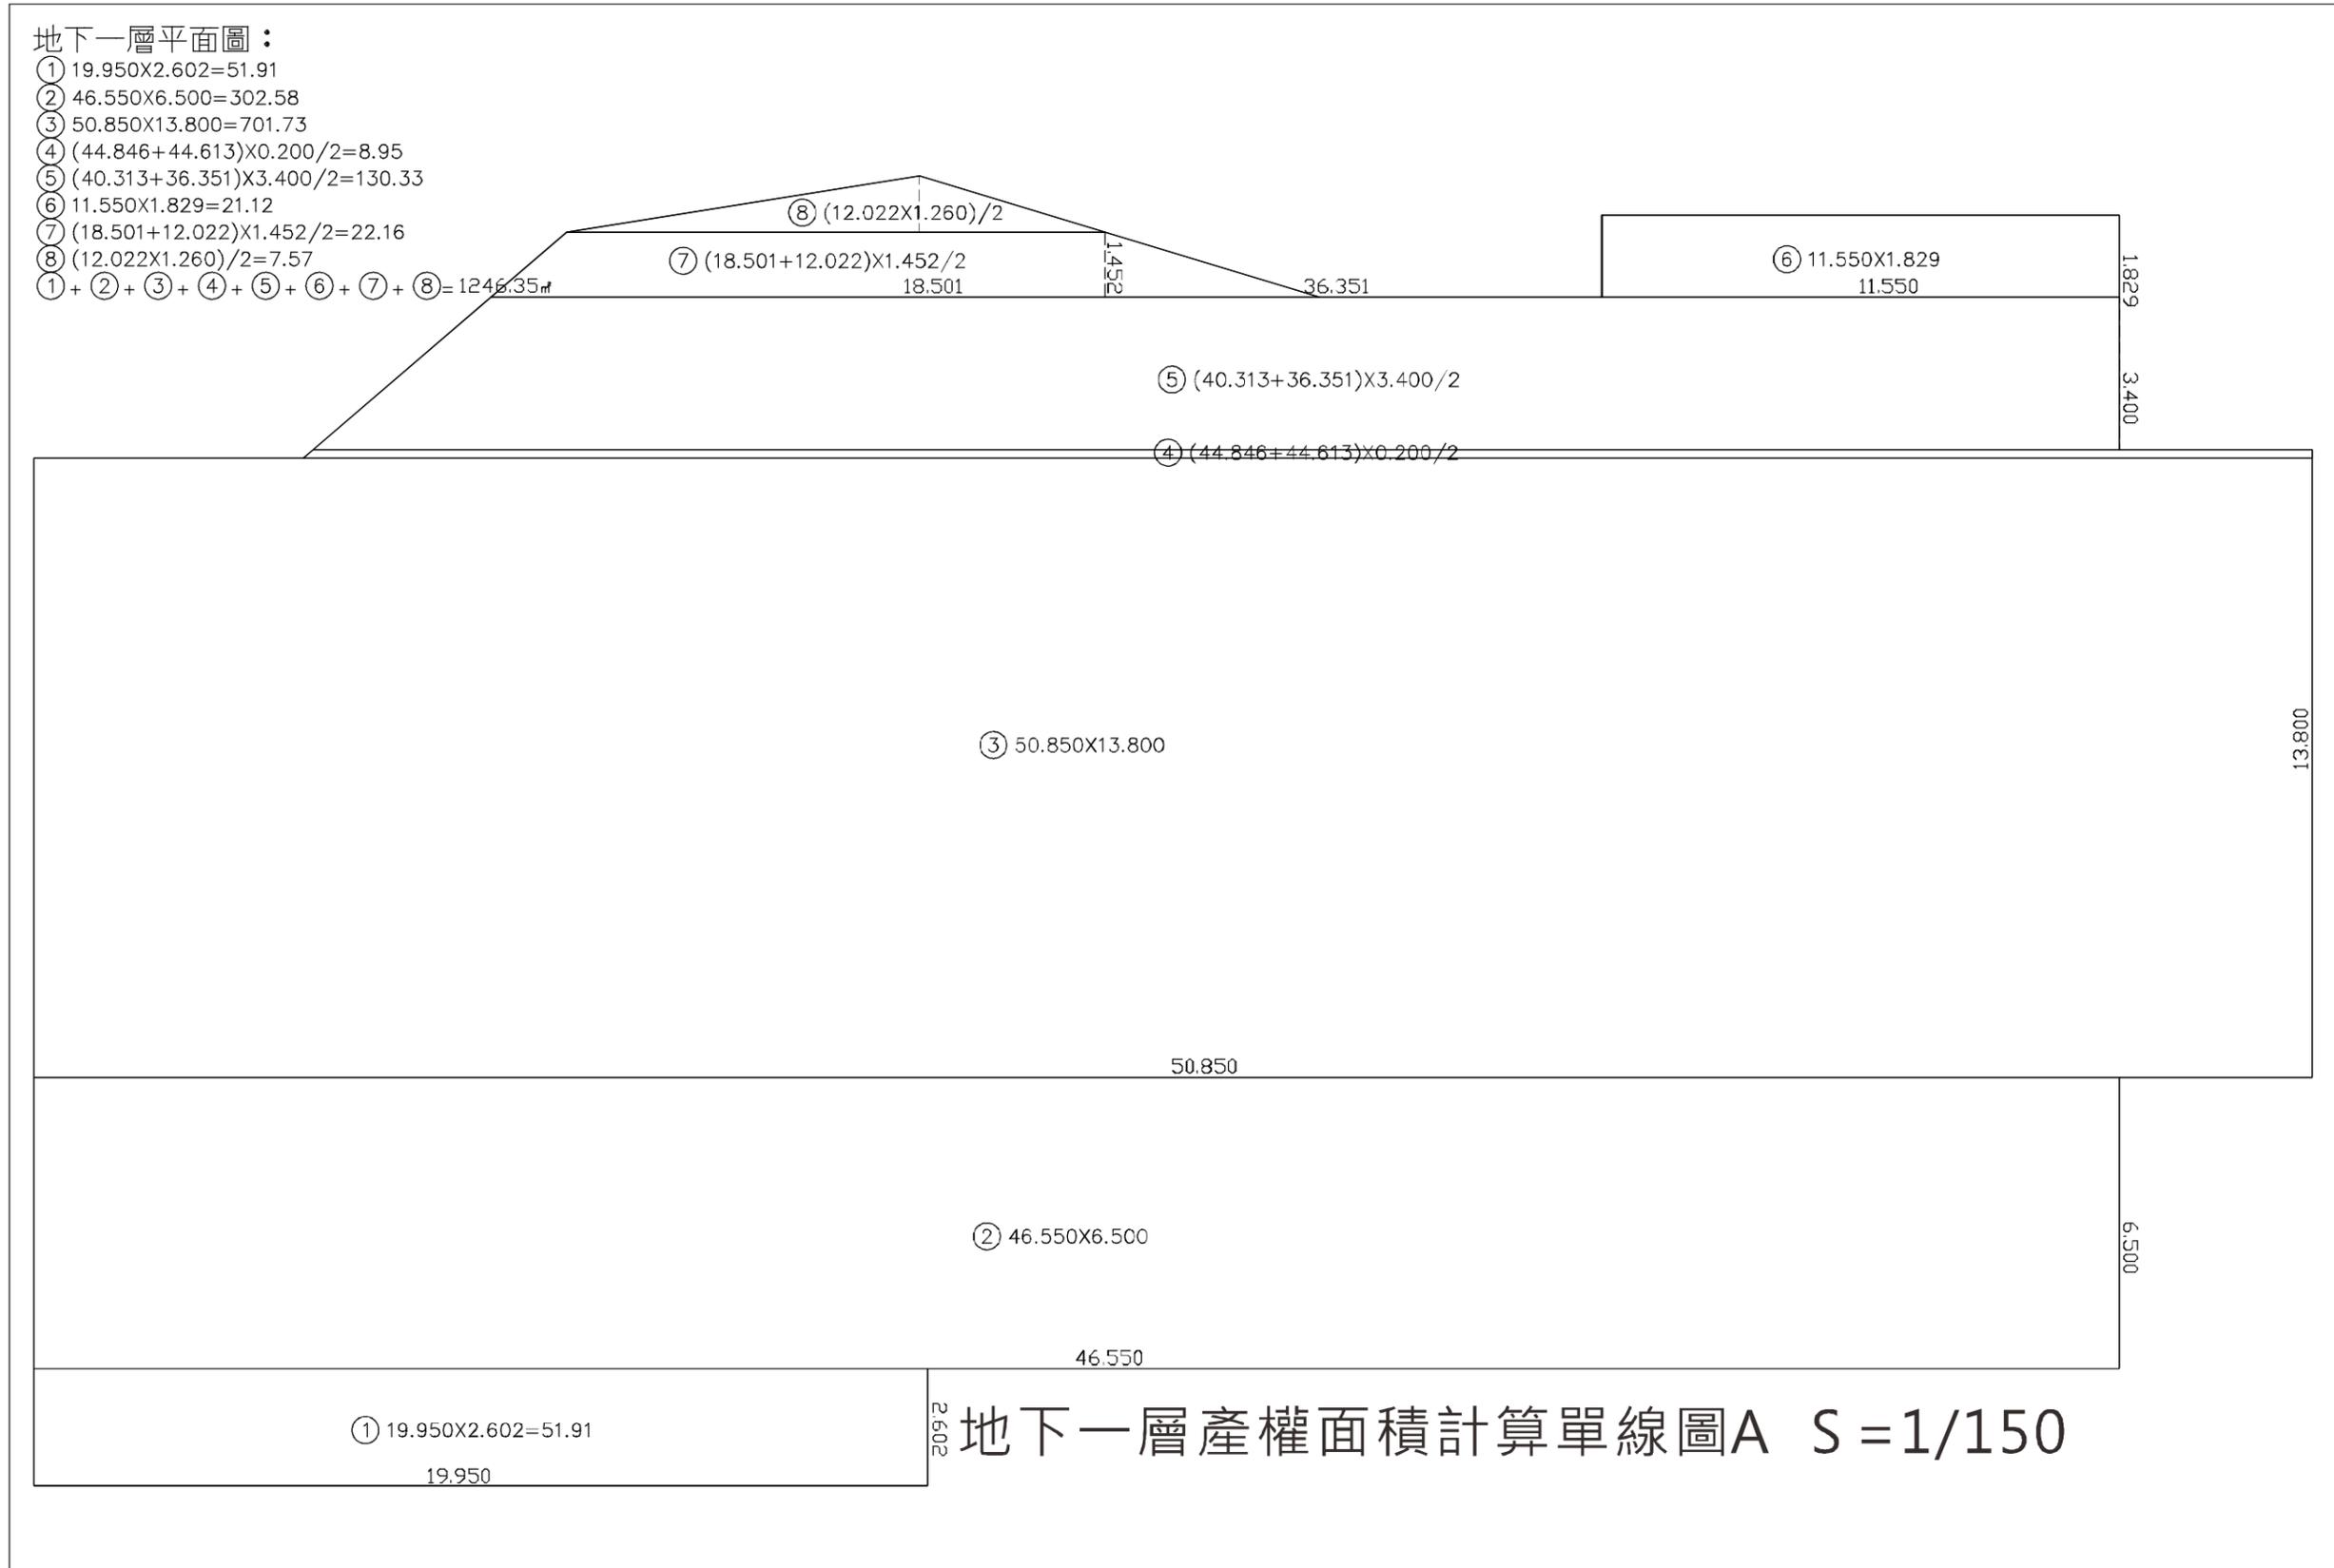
、地下一層產權面積計算單線圖A (S : 1/150)
